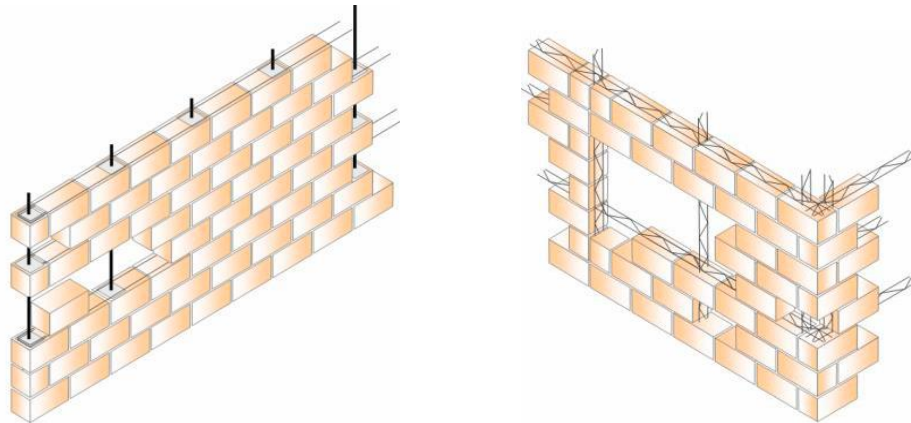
Alvenaria armada com armadura ordinária e alvenaria armada com armadura em treliças de aço inoxidável (Gouveia et al., 2007).
